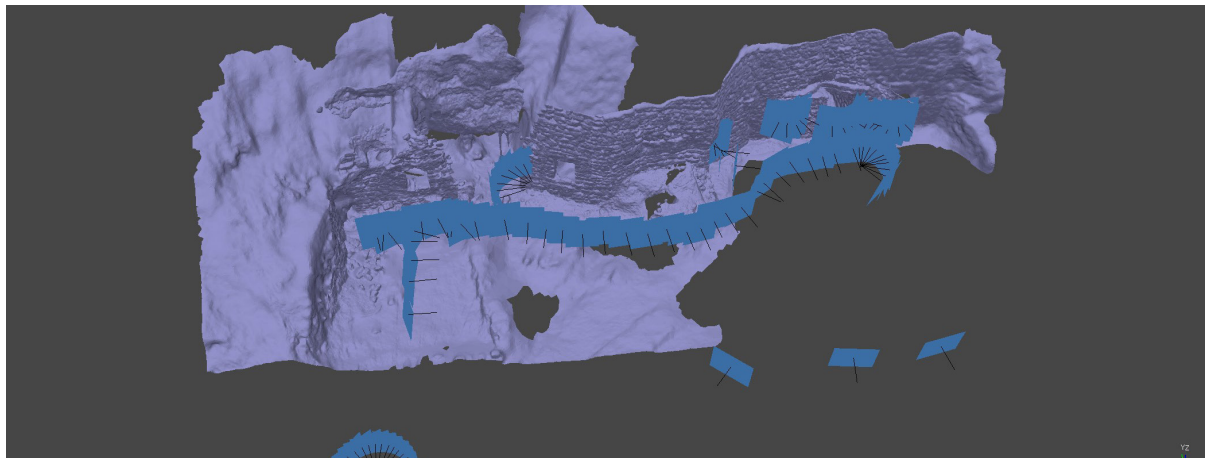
Levantamiento de la fachada en obras con los datos de Abril. Modelo sólido y posicionamiento de cámaras. Fuente: Elaboración propia
